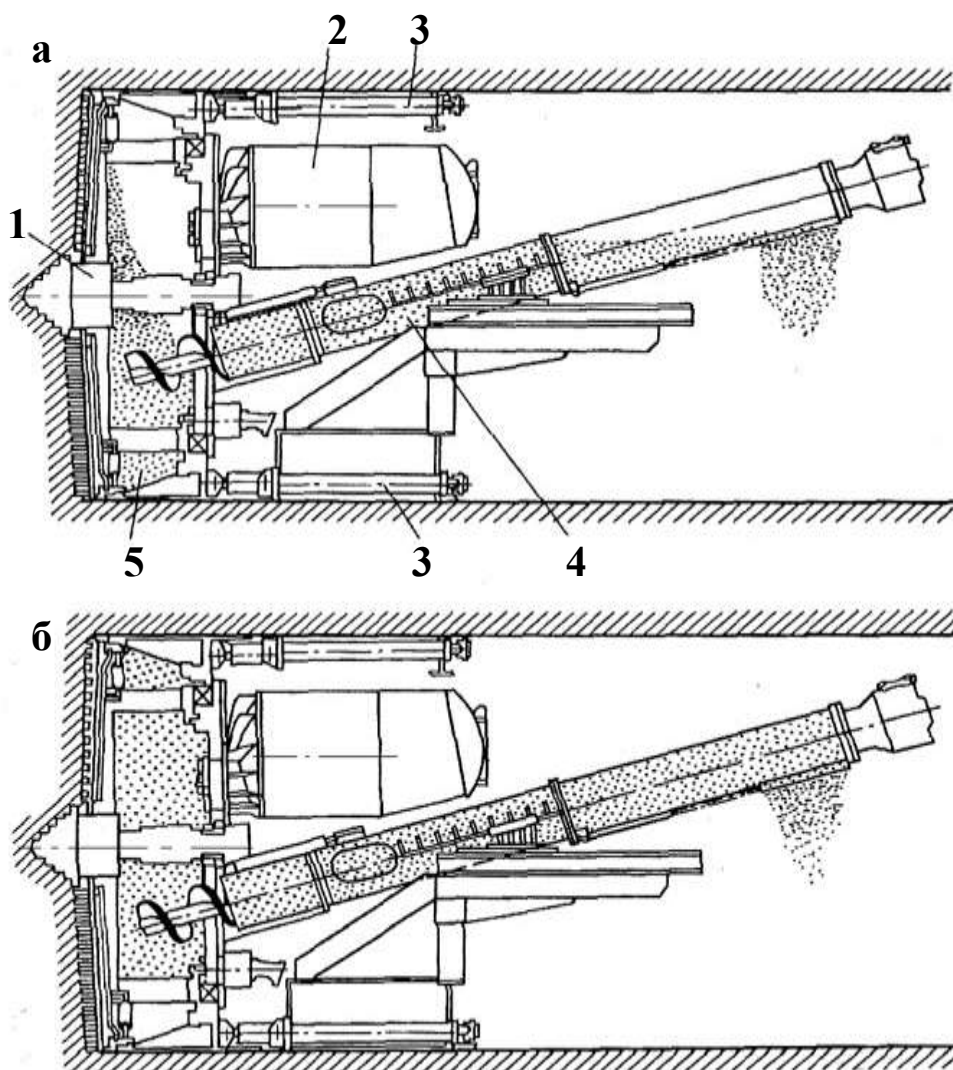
Режимы работы щита с грунтовым пригрузом:
